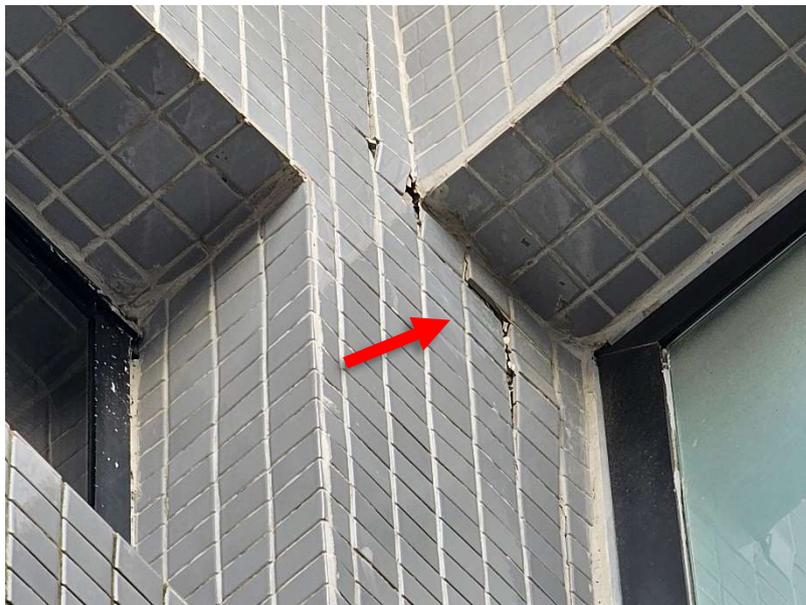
Foi constatado o destacamento do revestimento cerâmico da fachada do bloco principal, na altura do terceiro pavimento.
